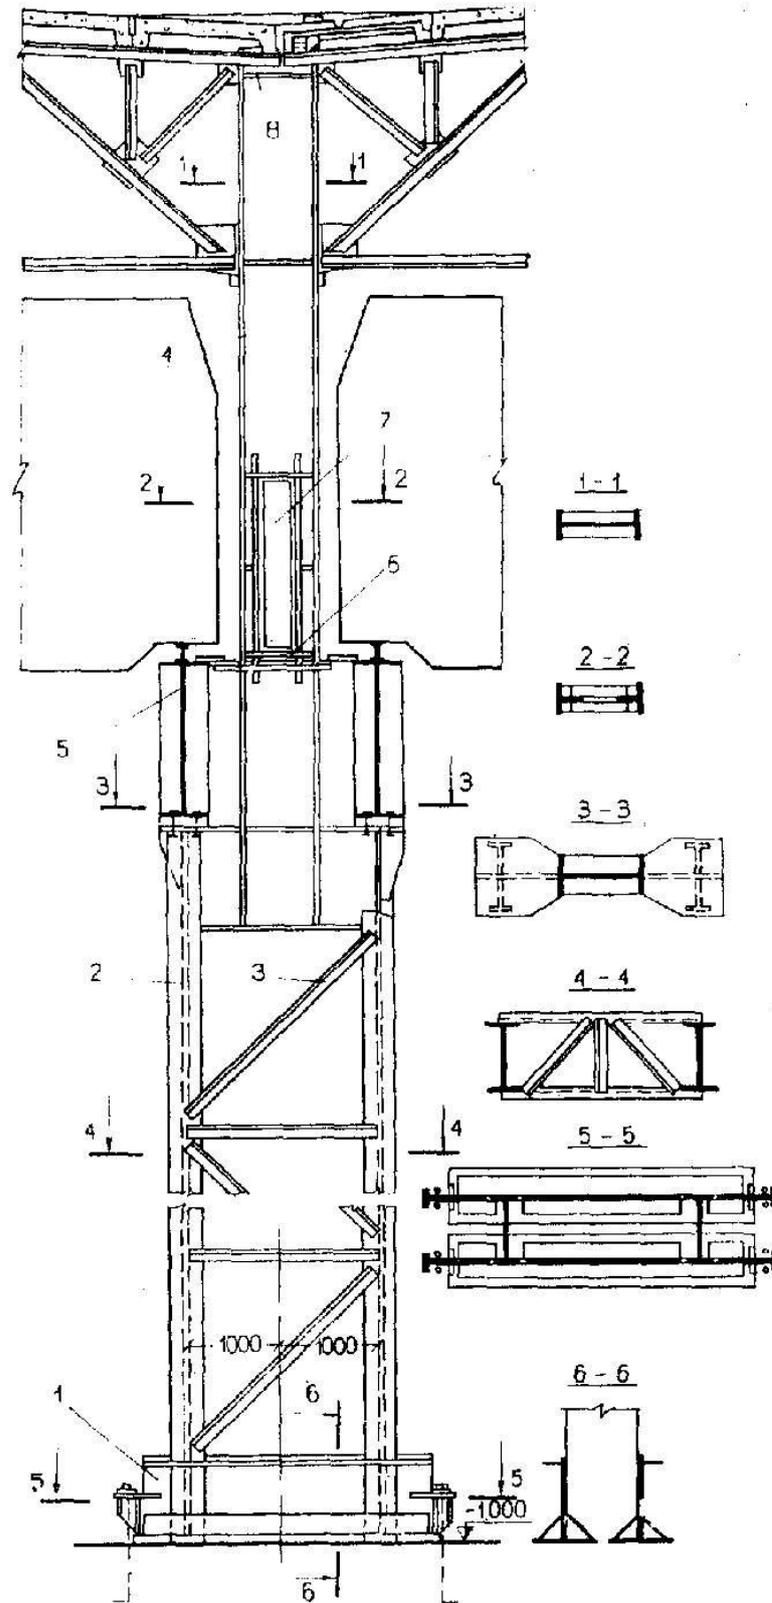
Сквозная стальная колонна переменного сечения со сплошным надколонником
